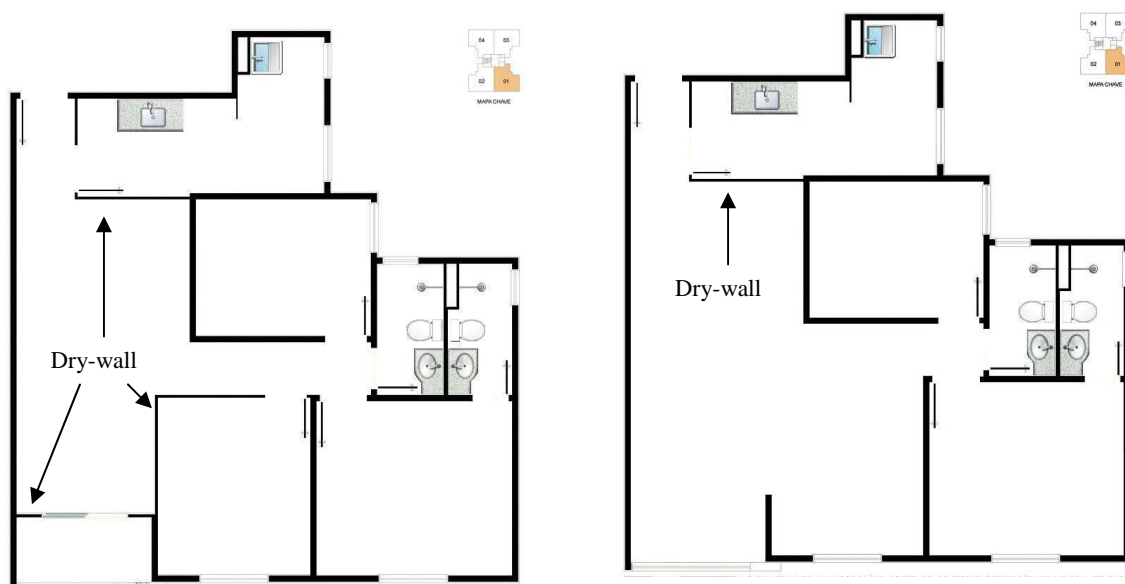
Variações da planta oferecidas ao cliente em apartamento em Águas Claras – DF.
